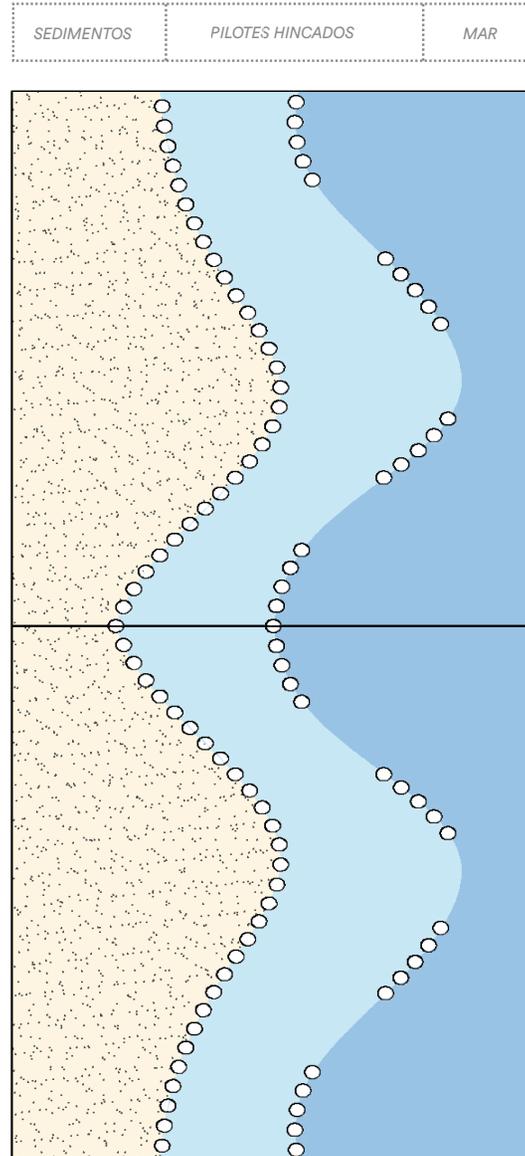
Planta modular escala 1:200 de recuperación de playa con sedimentos. Elaboración propia
